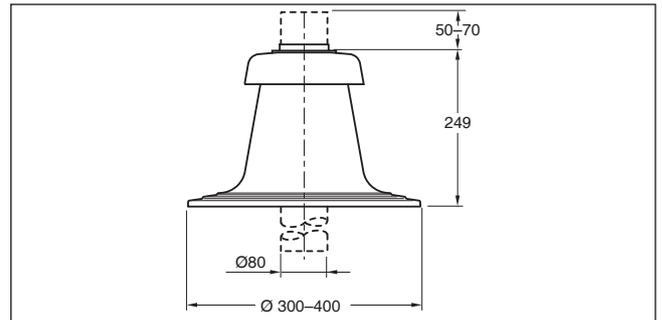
Schachtabdeckung für 80 mm (Maße in mm)
